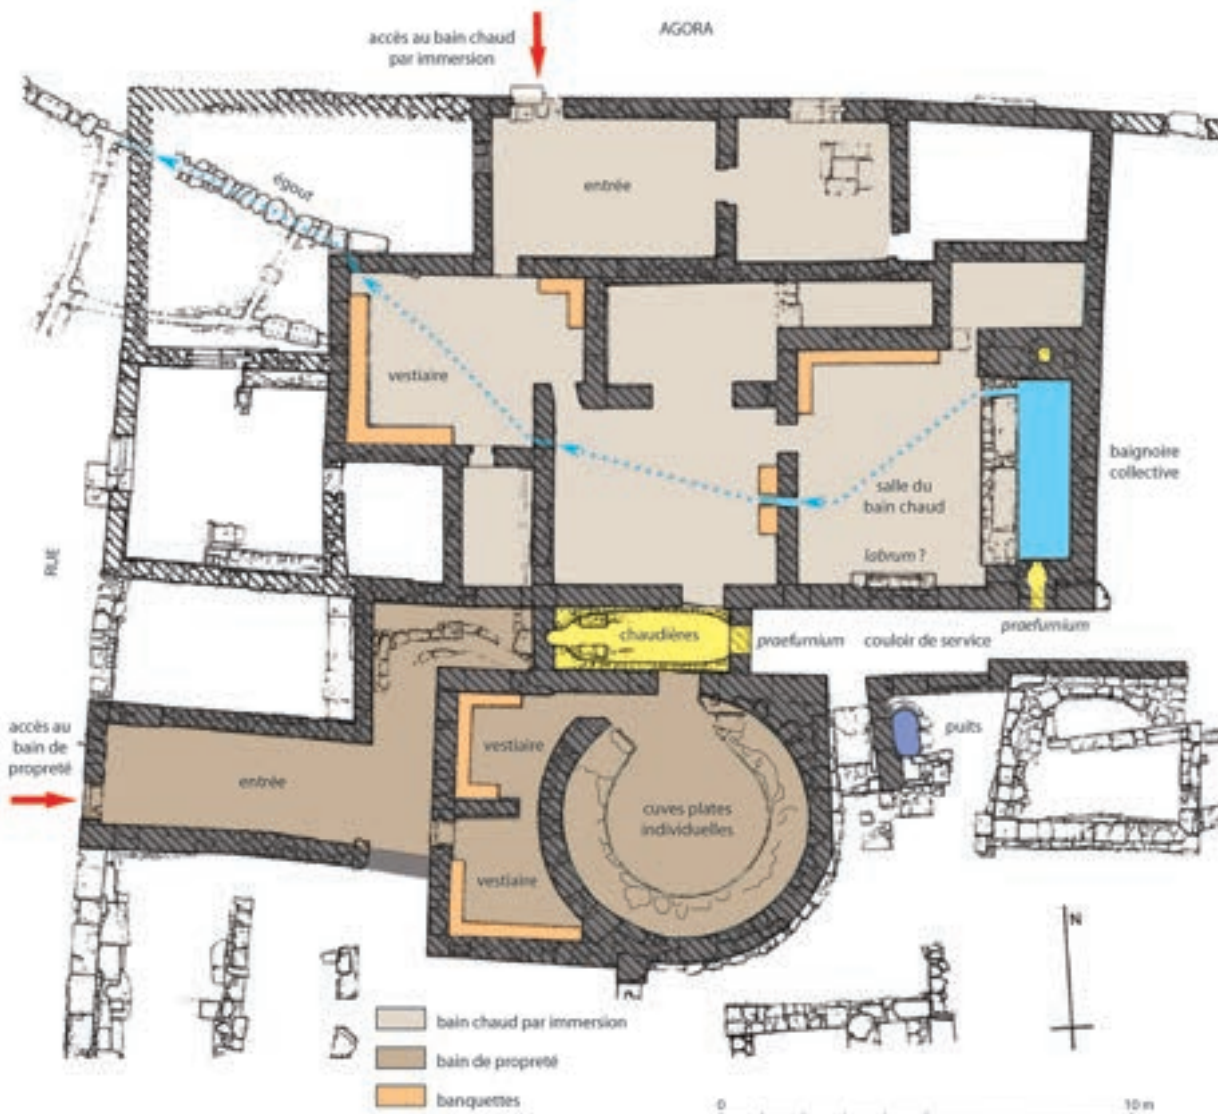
Plan des bains de Mégara Hyblaea (fond de plan A. Giucastro).
